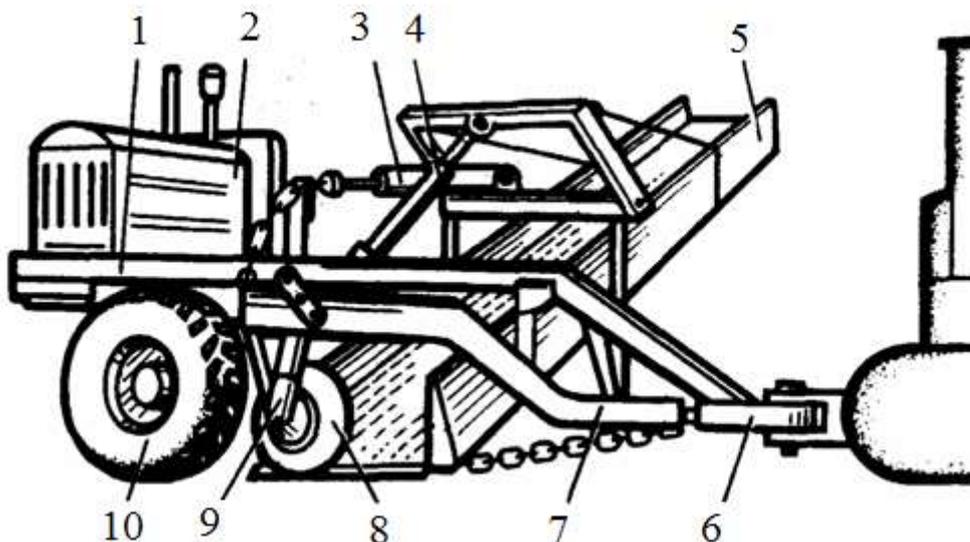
Грейдер-элеватор: 1– рама; 2–двигатель; 3, 4– гидроцилиндры; 5–конвейер; 6– сцепное устройство; 7 плужная балка; 8– дисковый плуг; 9– кронштейн; 10–колеса.
